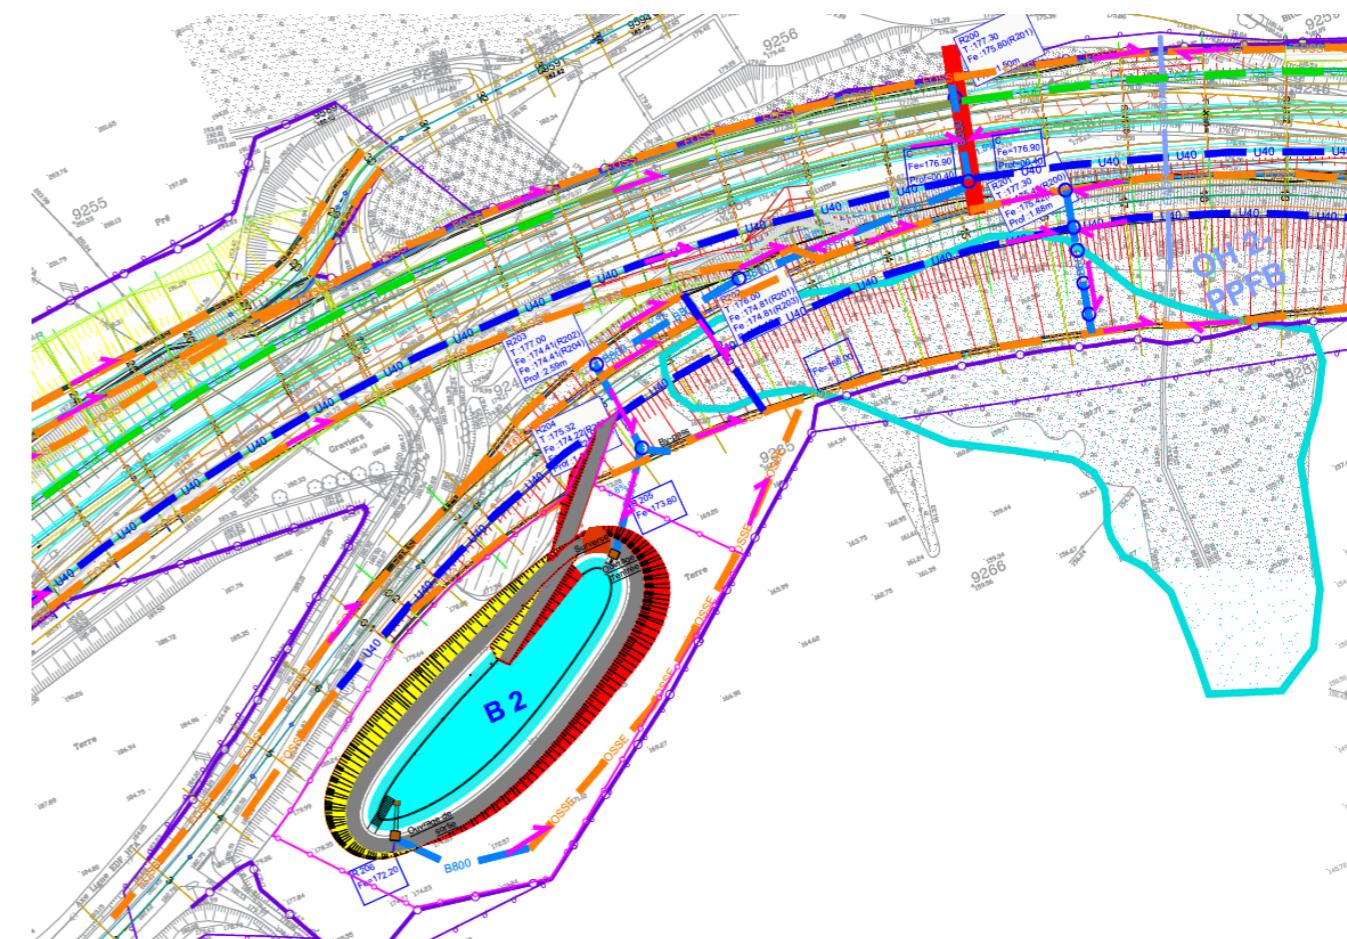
Plan d'assainissement du BR2 (source : SIR)
